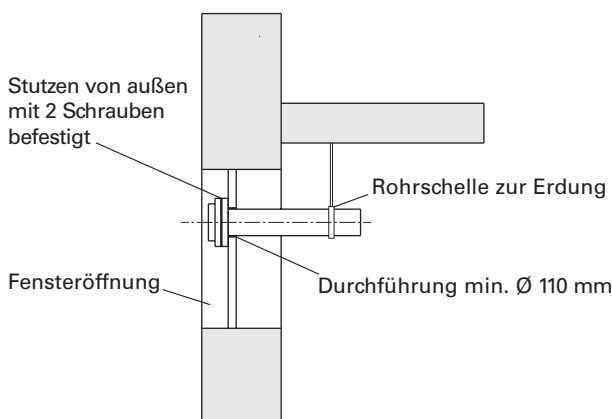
Stützen Fensterdurchführung – Seitenansicht
